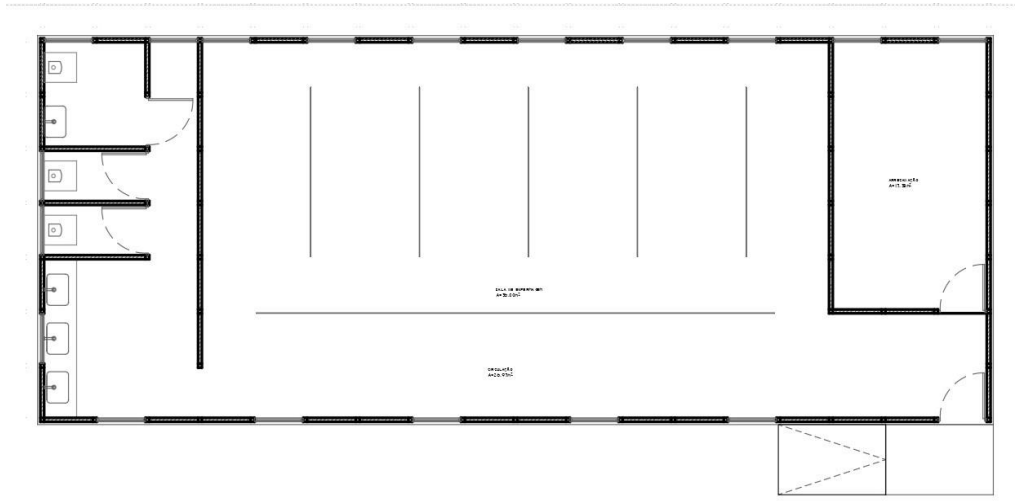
Planta Piso O Módulo Enfermaria Comunitária (Fonte: Autor)
